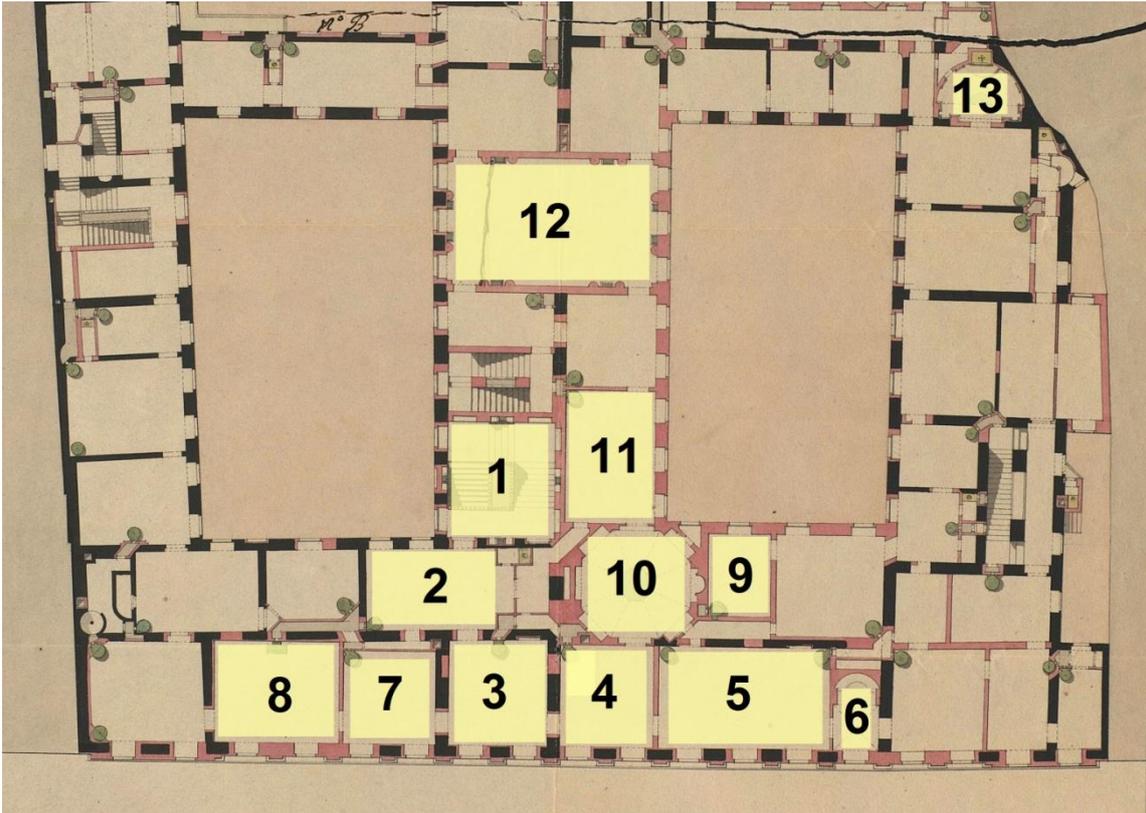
Grundriss des 1. OG des Stadtpalais Modena.
